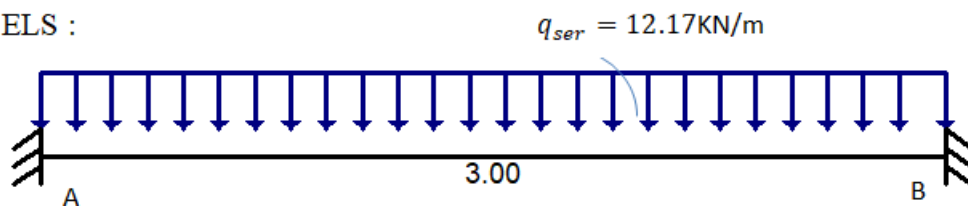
Schéma statique de la charge appliquée sur la poutre de palier (ELS)
